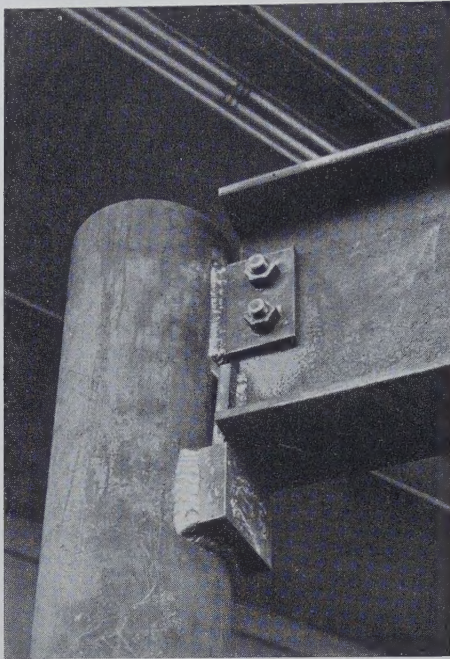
Deckenträgerauflagerung an der Fassadenstütze mit angeschweißter Knappe (Versuchsstück)
